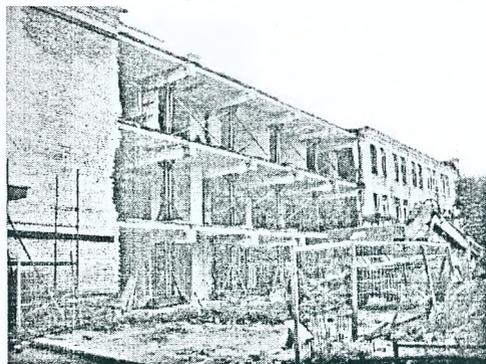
Вид здания АБК при демонтаже кирпичной стены первой захватки
